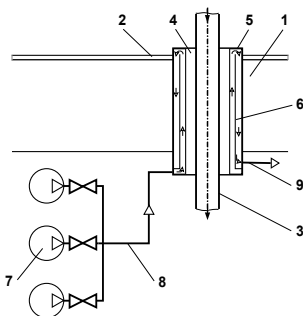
Схема системы активного охлаждения гермопроходки с помощью принудительной циркуляции воздуха, применяемая на АЭС с ВВЭР: 1 – бетонное перекрытие гермооболочки; 2 – гермооблицовка; 3 – трубопровод системы продувки парогенератора; 4 – теплоизоляция; 5 – гермопроходка; 6 – обечайка разделения потоков воздуха; 7 – вентилятор; 8 – трубопровод подачи охлаждающего воздуха; 9 – отвод охлаждающего воздуха
